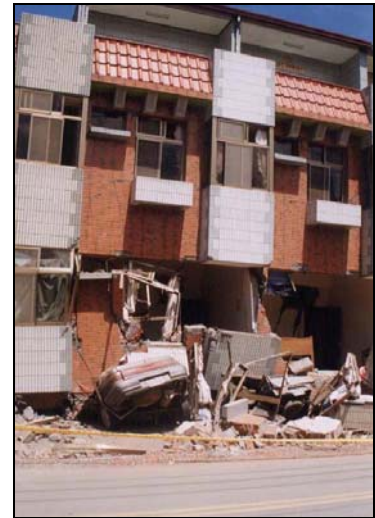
Colapso de estructuras durante el terremoto de Northridge 1994.
